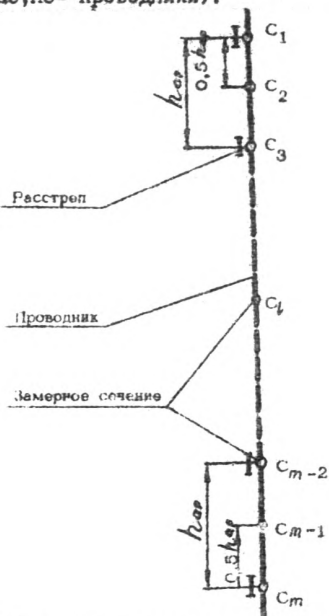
Схема расположения замерных сечений по длине ятки проводника (C1, C2, ..., C - замерные сечения; $h_{ар}$ - шаг армировки)
